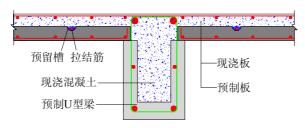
钢筋混凝土 U 型叠合梁截面
